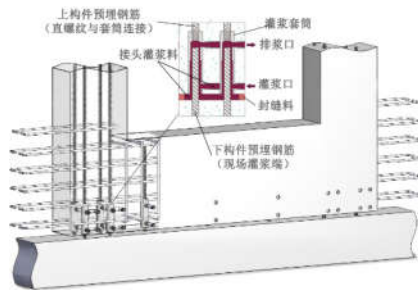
预制混凝土剪力墙中的套筒灌浆连接技术
